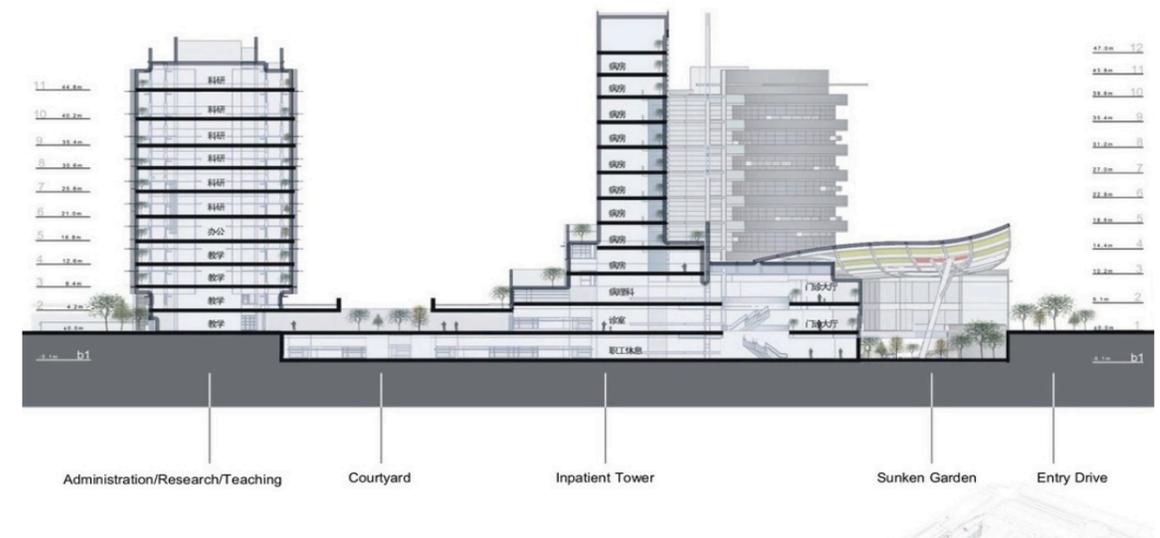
Sezione longitudinale dell'ospedale pediatrico di Suzhou
